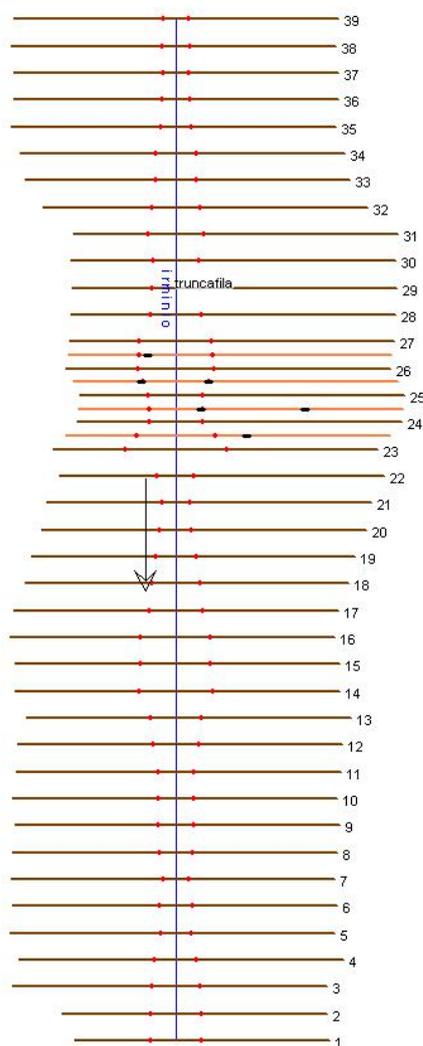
Schema planimetrico delle sezioni usate per il calcolo e posizione delle pile del viadotto in progetto (tratti in nero)
